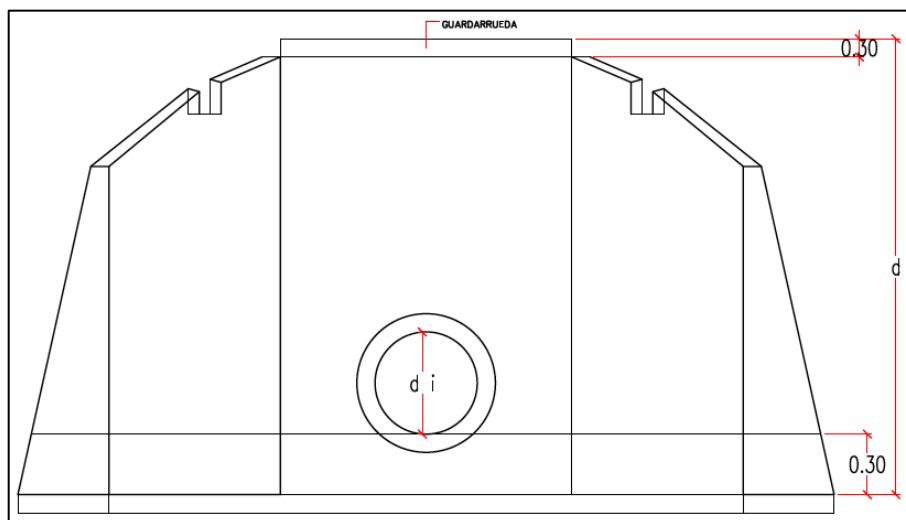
Corte de las estructuras hidráulicas a construir en el proyecto de Rionegro-Santander
